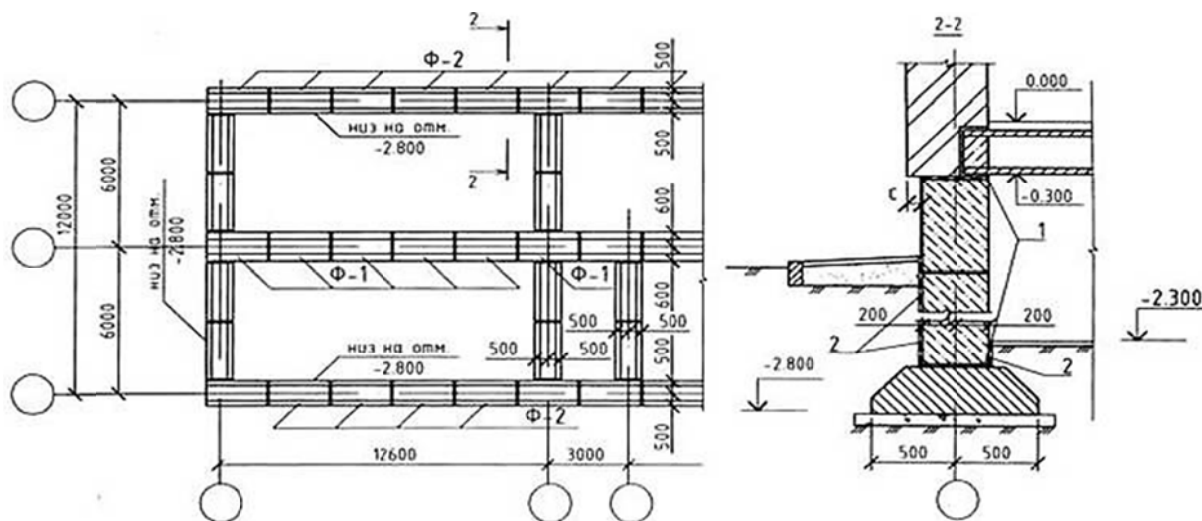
План и разрез ленточного сборного железобетонного фундамента
